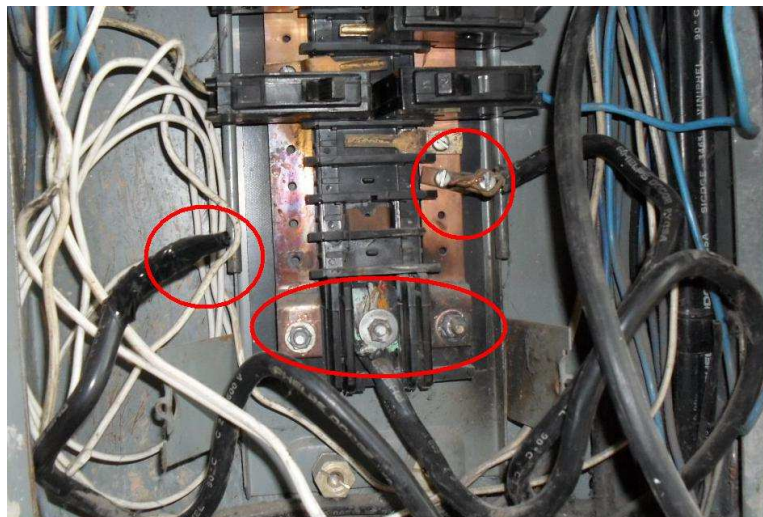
Detalle de las barras, zapatas y conductores de entrada del tablero 3F
